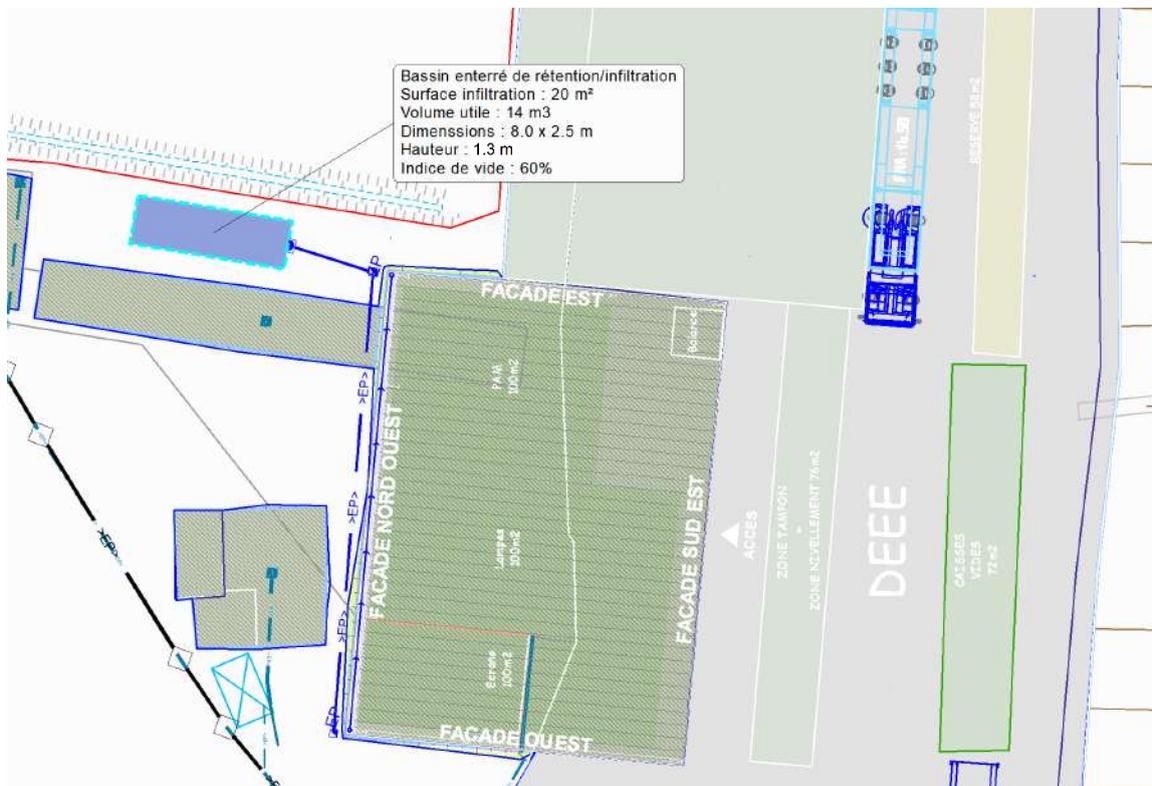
Plan de principe implantation rétention/infiltration EP toitures
